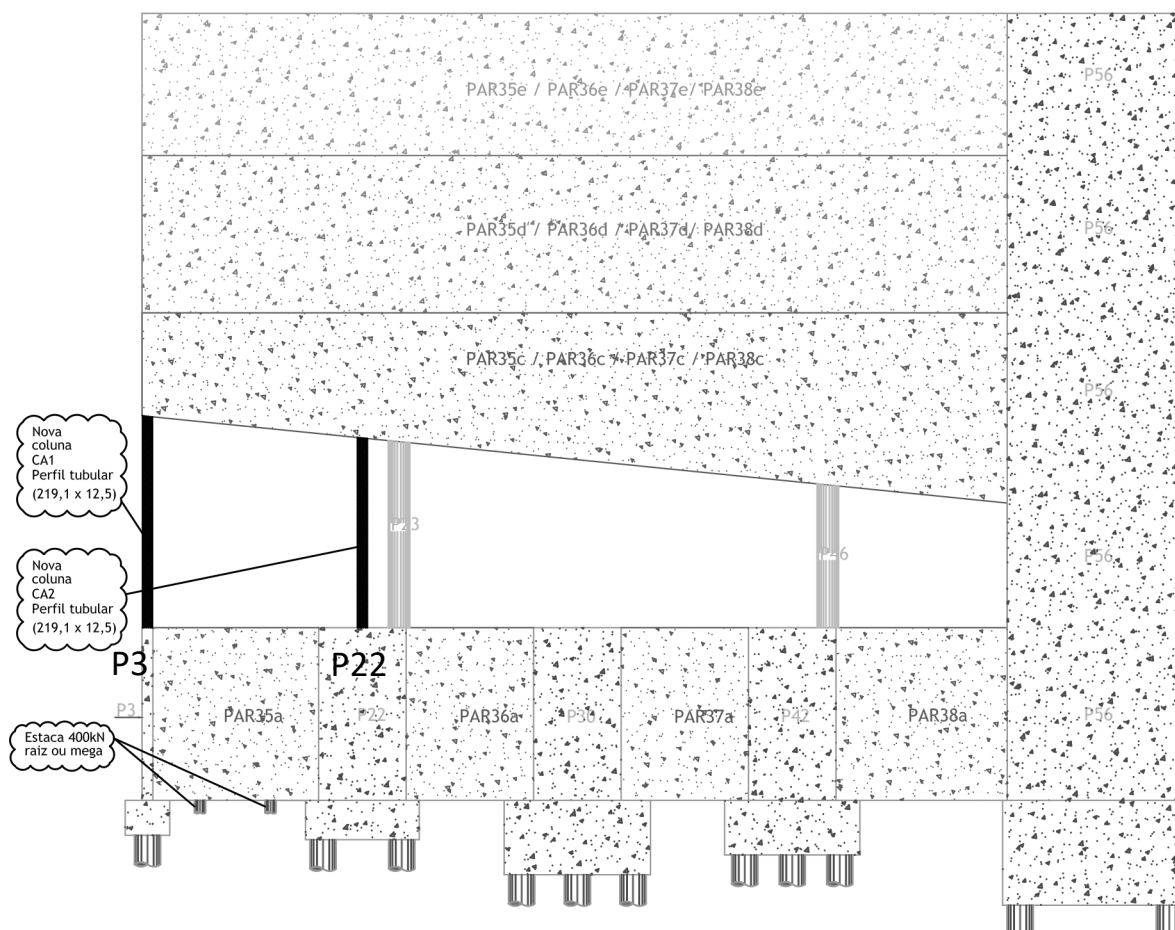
Croqui da PAR35 com a inserção de pilar de reforço.
